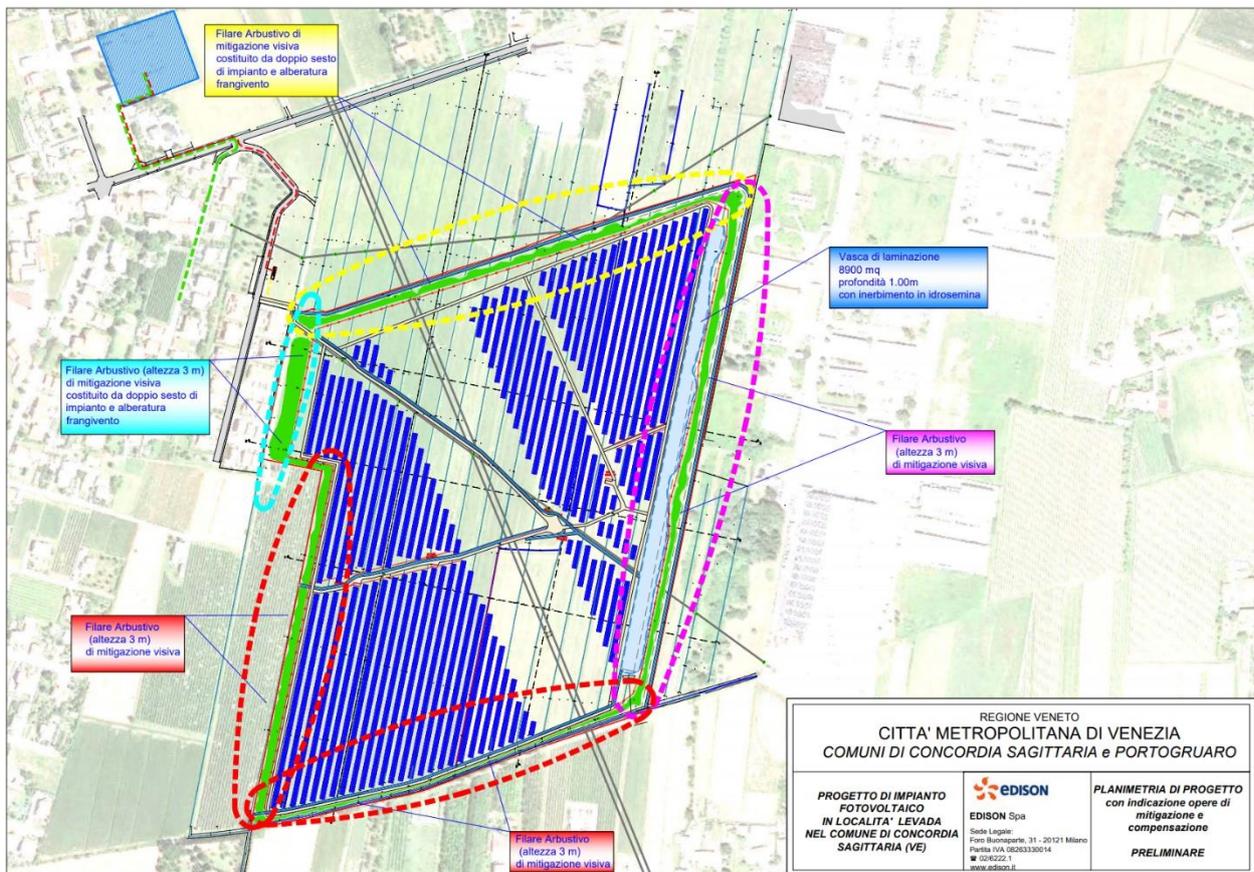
Planimetria con individuazione delle opere di mitigazione
